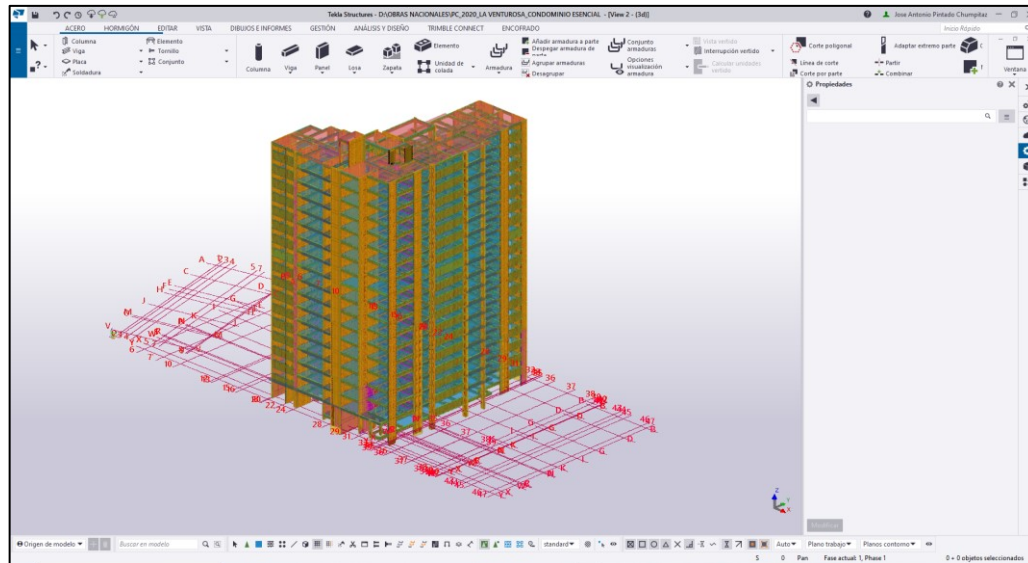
Modelado y detallado de concreto y armadura en Tekla Structures 2020 Fuente: Elaboración propia
